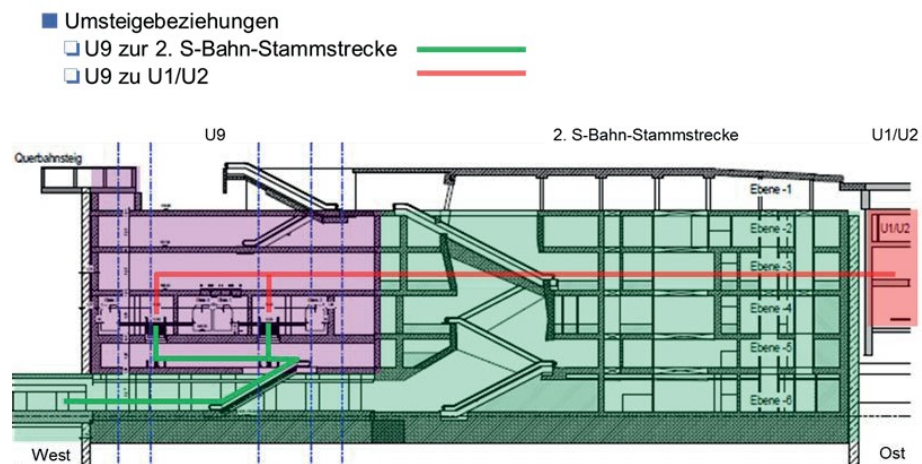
Schnitt durch den Baukörper mit Umsteigebeziehungen
